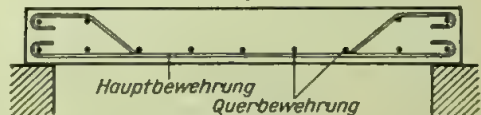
Bewehrung einer Stahlbetonplatte
